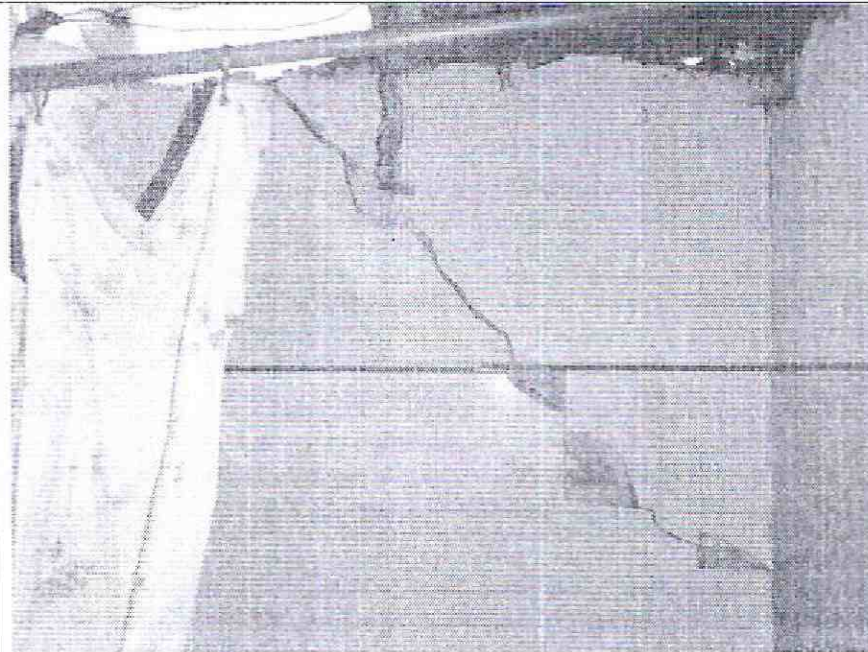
Agrietamiento muro del baño localizado en el sector 3
